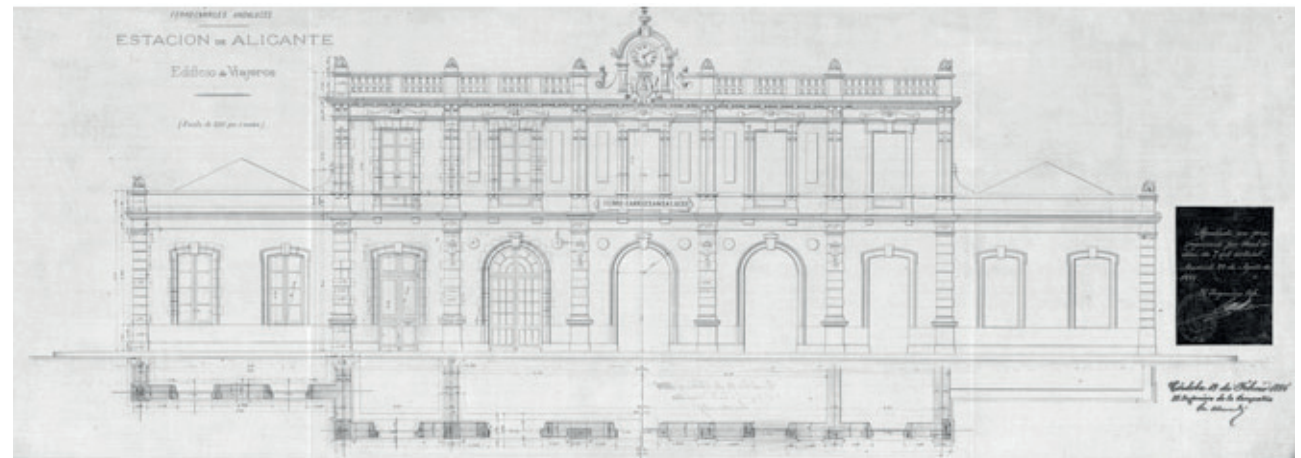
Plano original de la fachada principal de la estación de Benalúa
